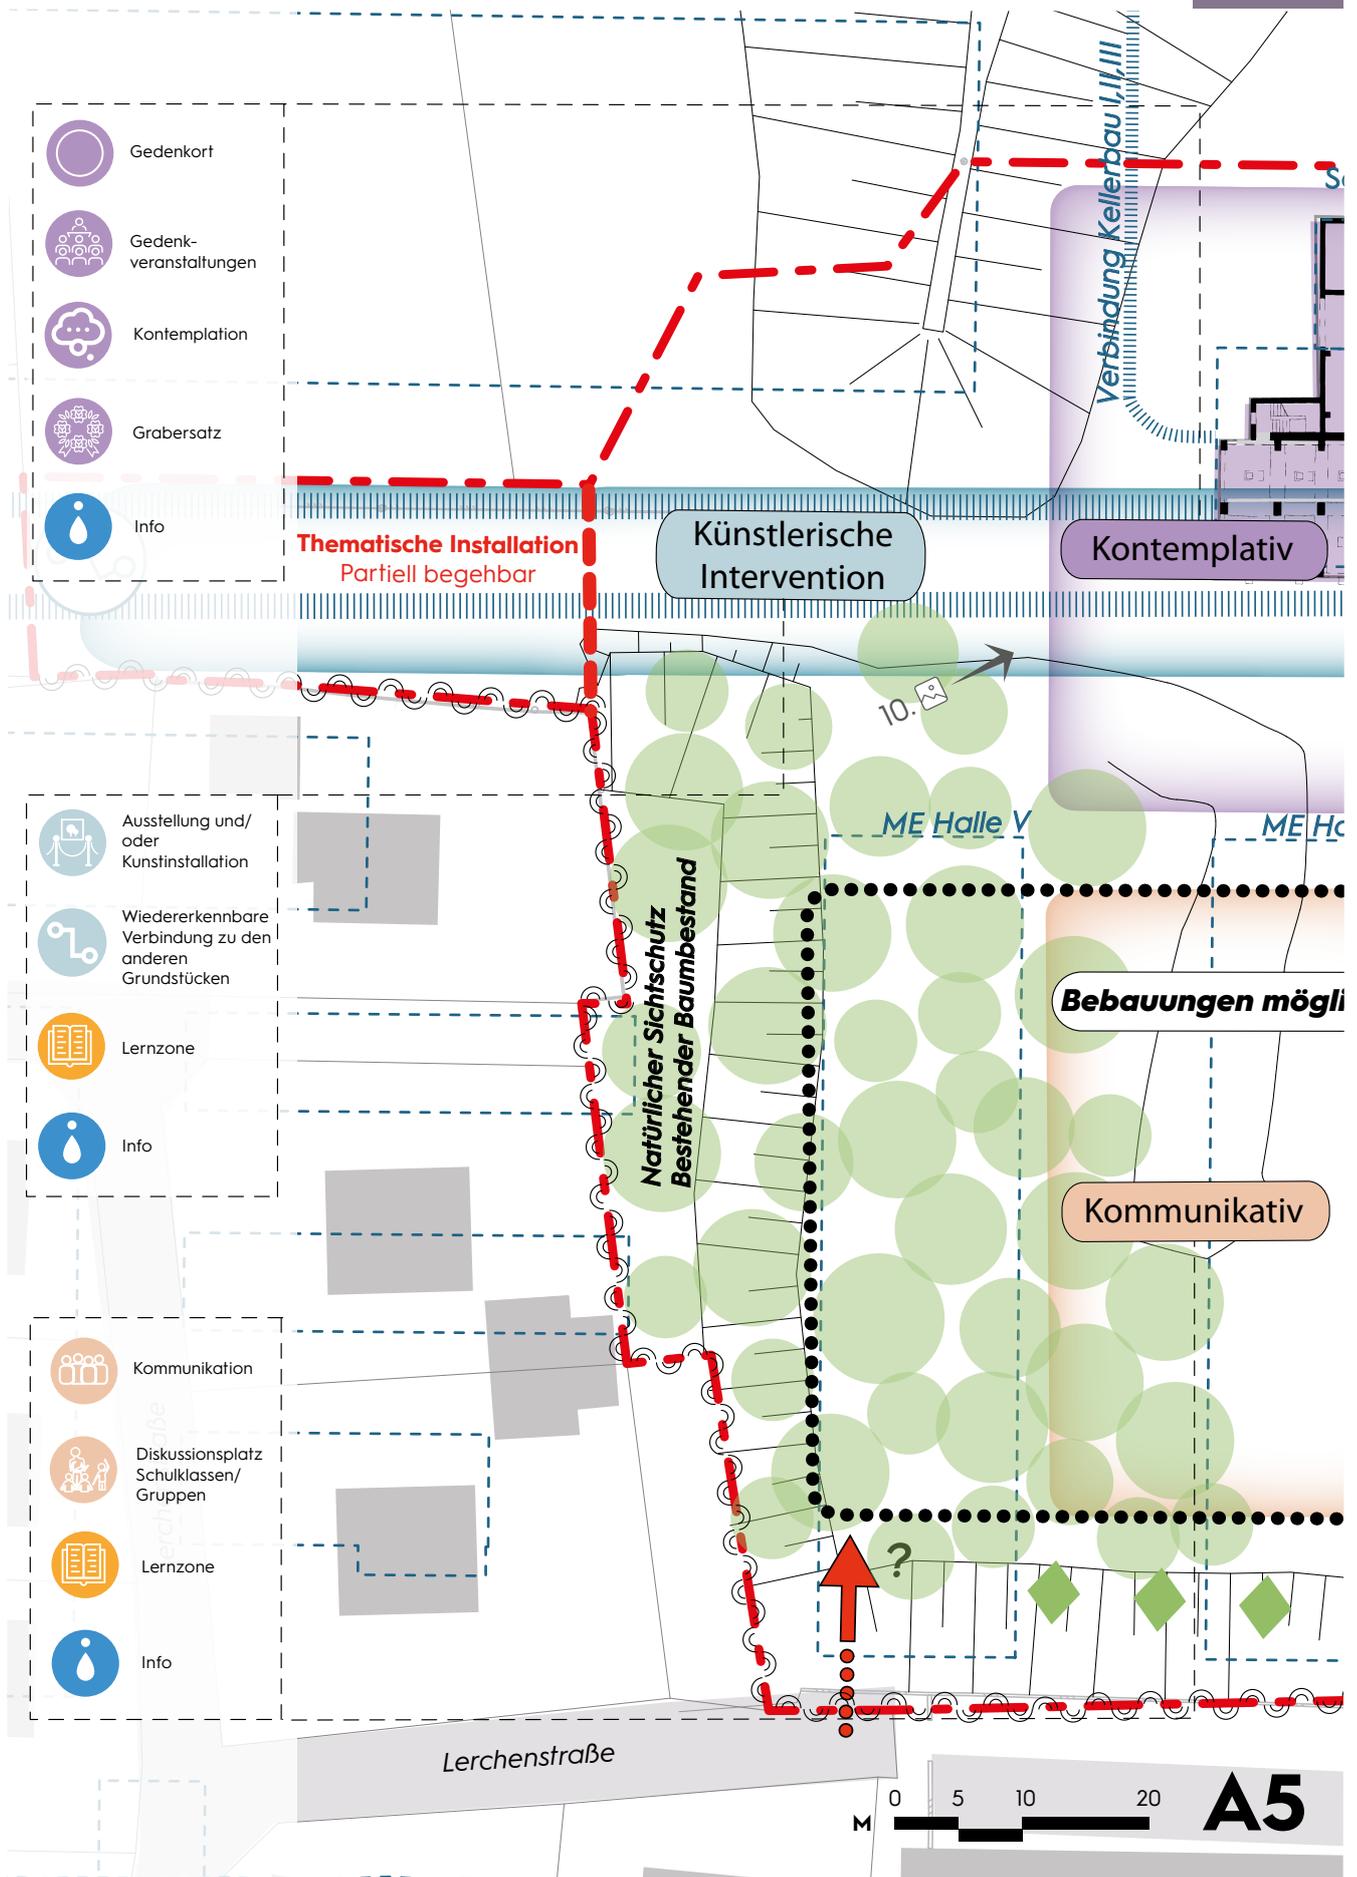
Masterplan Grundriss Appellplatz (Ausschnitt A5)
